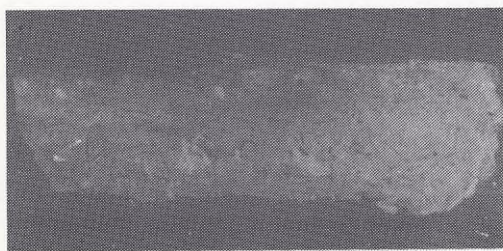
Snitt genom betongprov (travertinliknande betong).
